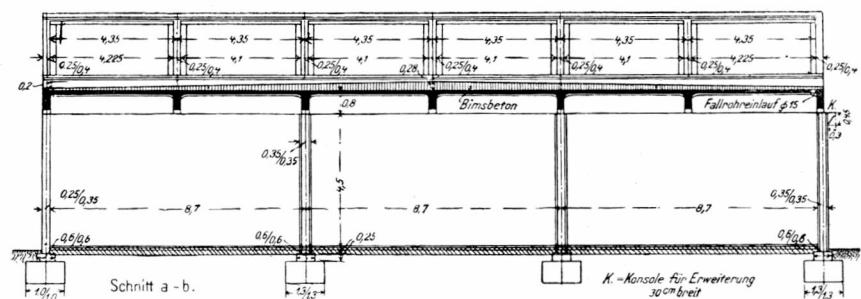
Shedhalle im Querschnitt. (Rudolf Wolle, Leipzig)
